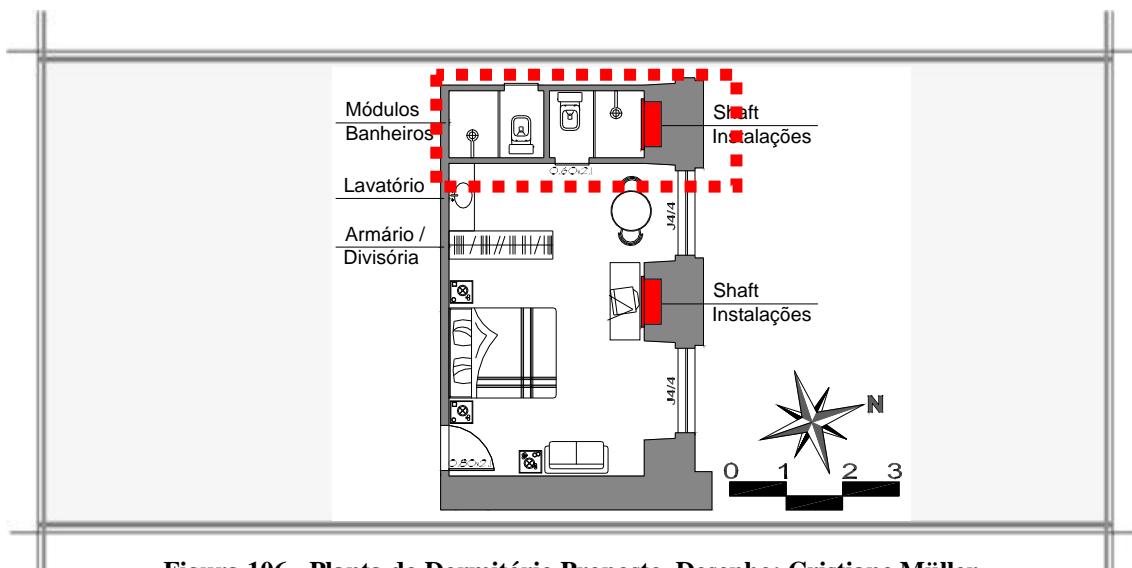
Planta do Dormitório Proposto. Desenho: Cristiane Müller.
